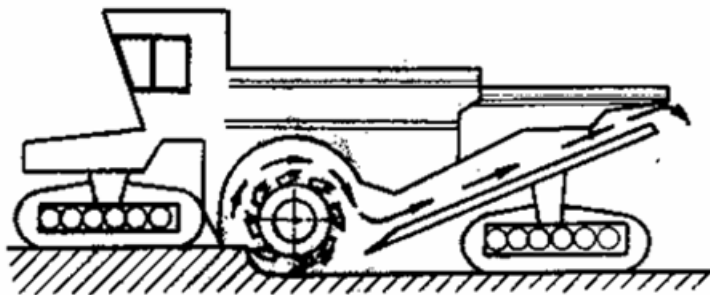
Схема роботи фрезерного комбайна "Віртген"
